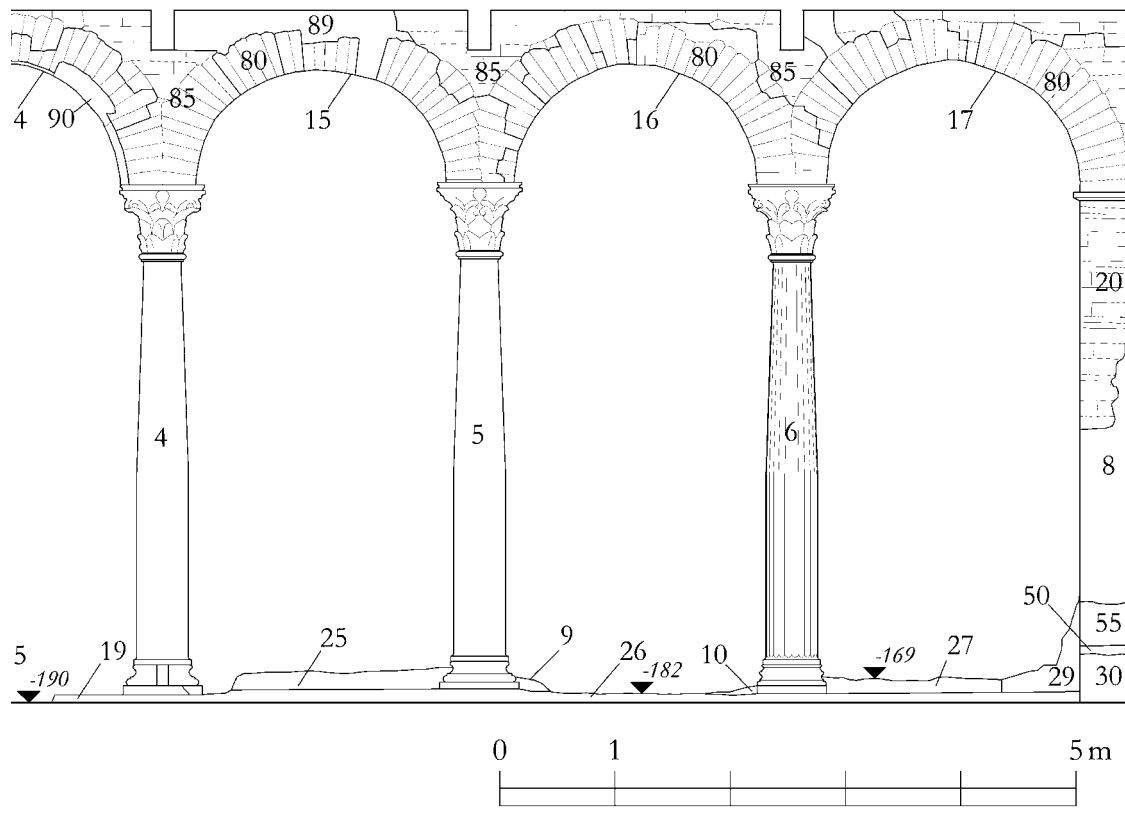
Prospetto interno del lato E dell'atrio (2008).
